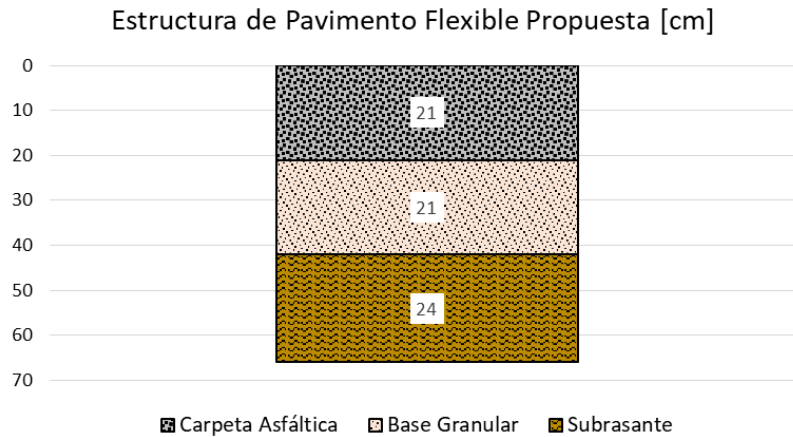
Estructura de Pavimento Flexible Propuesta
